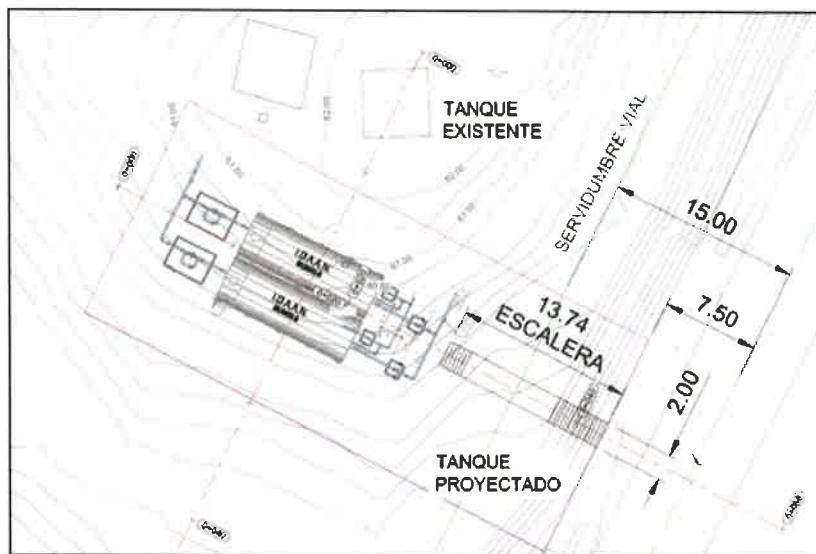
Vista en planta de escalera de acceso proyectada
